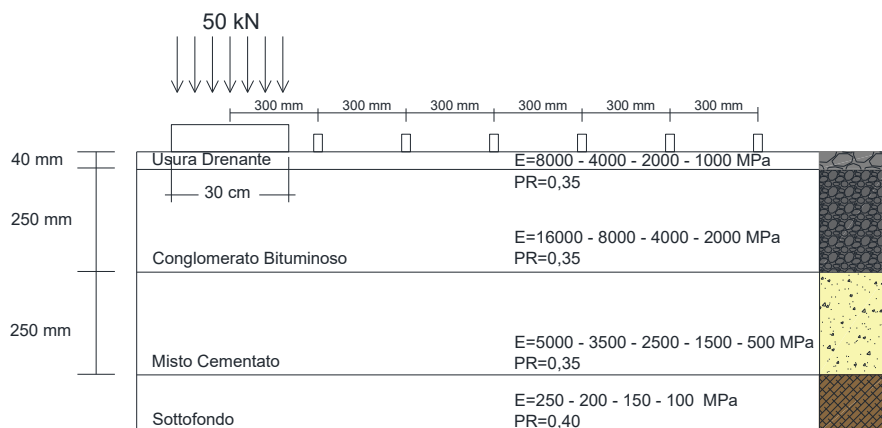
Stratigrafia pavimentazione autostradale con usura drenante
